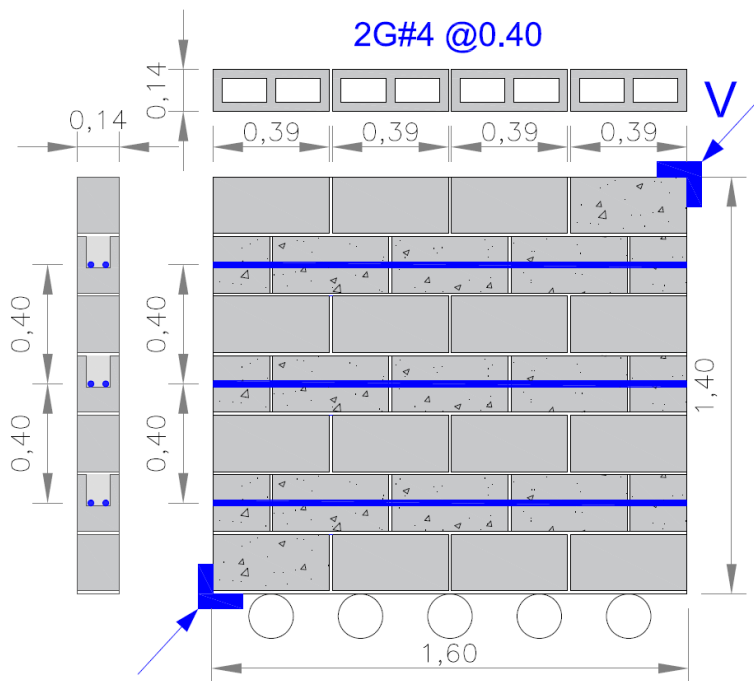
Configuración del refuerzo del muro MD-2#4/40
